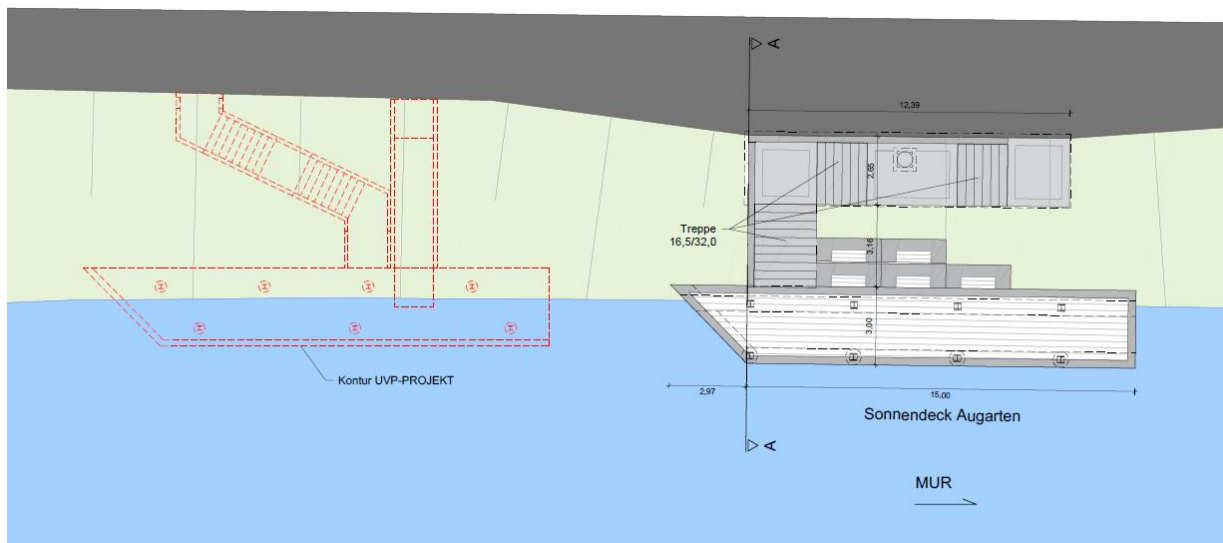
Lageplan Ausführung Sonnendeck Augarten (aus KOL\_LP\_SCH\_Sonnendecks\_Teil1\_20241217)
